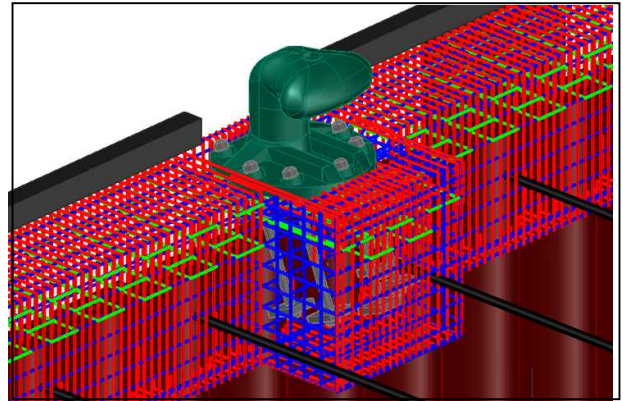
上部コンクリート工の詳細度400（過密配筋部）のモデル事例（清水岸壁）
